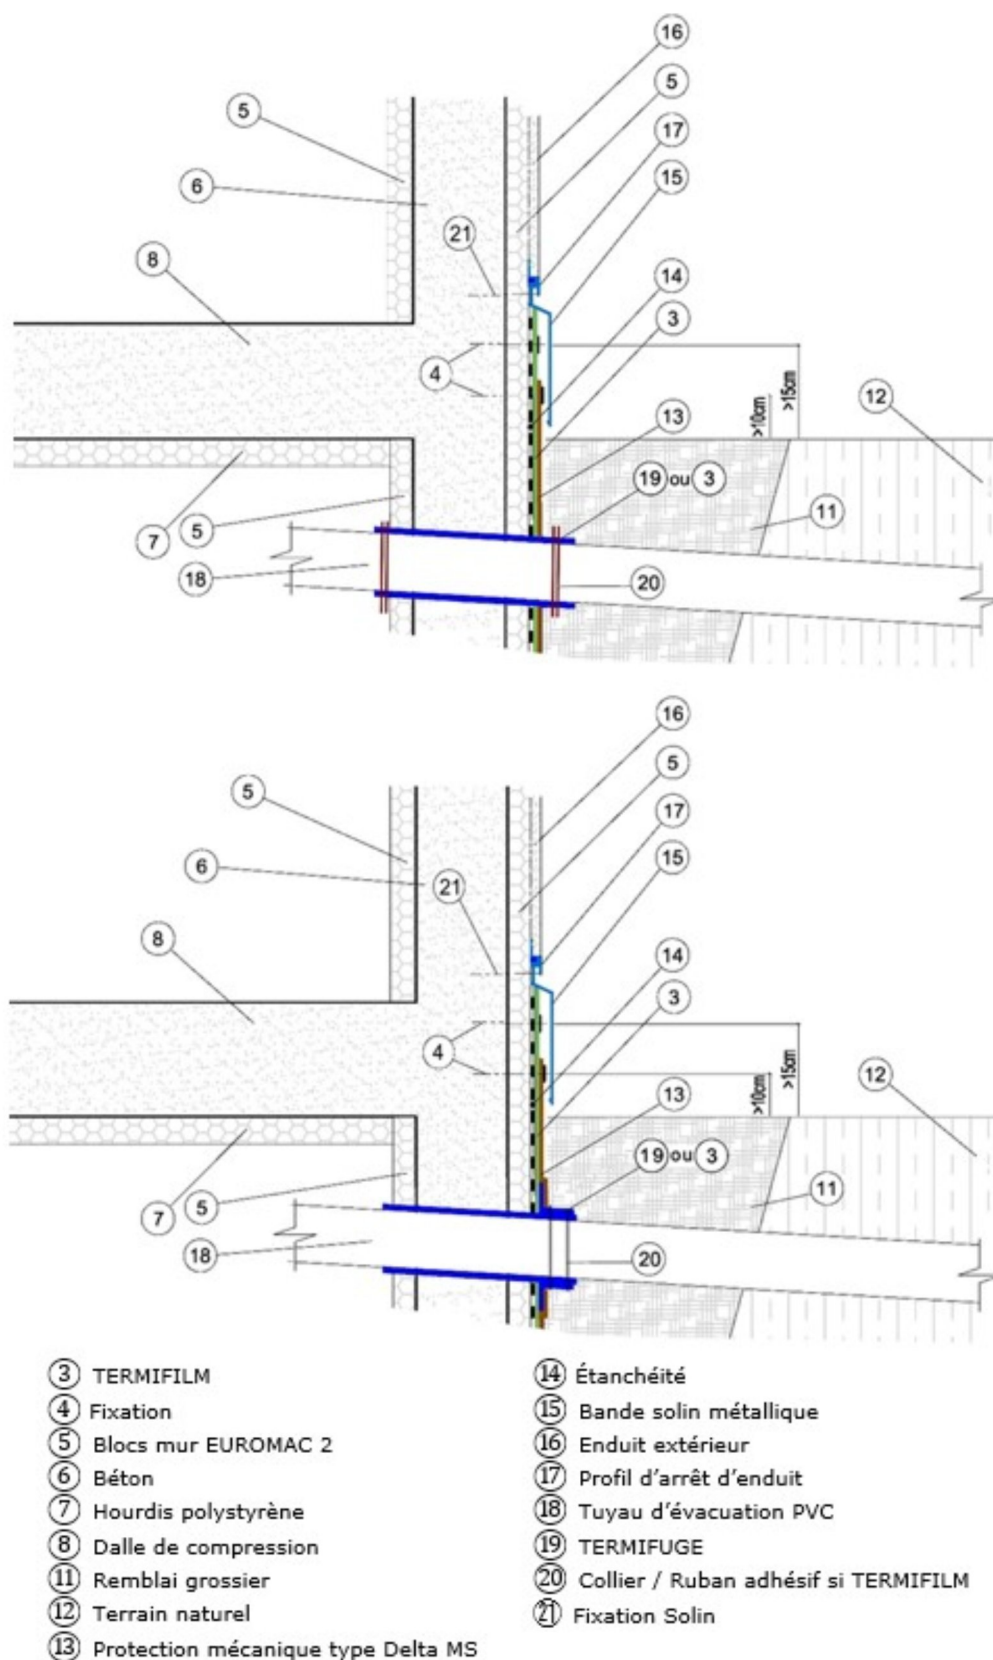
Traitement des traversées horizontales sur mur extérieur enterré
